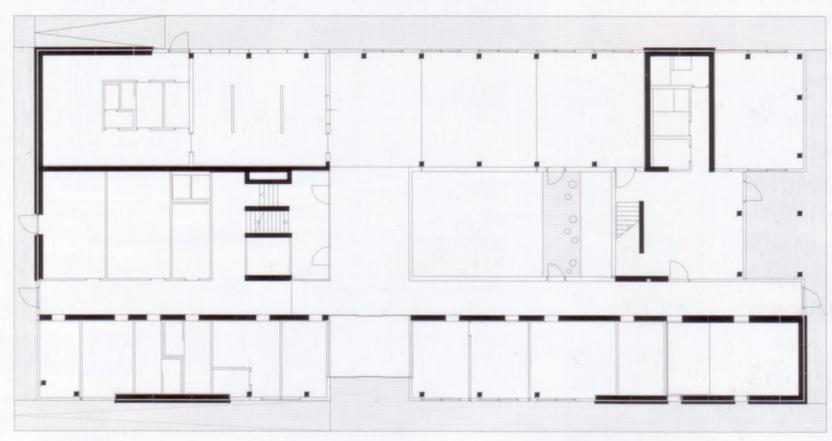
Grundriss Erdgeschoss M 1:500
